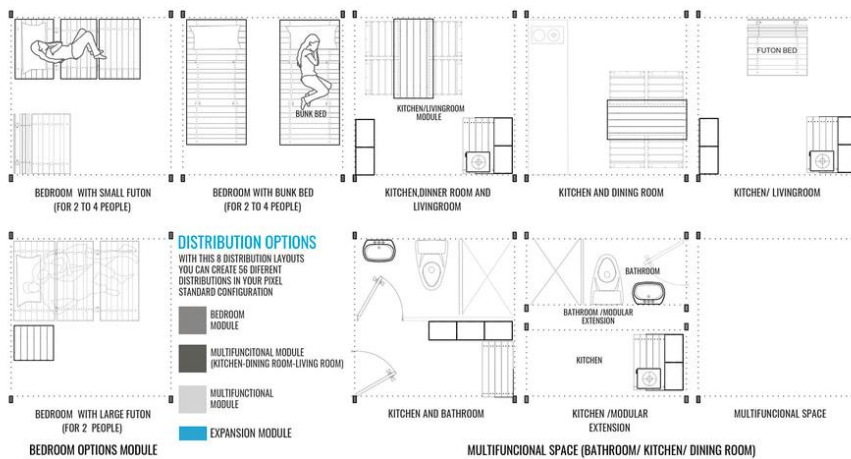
Planta tipo. Fuente: Barillas, L et all. (2017).
